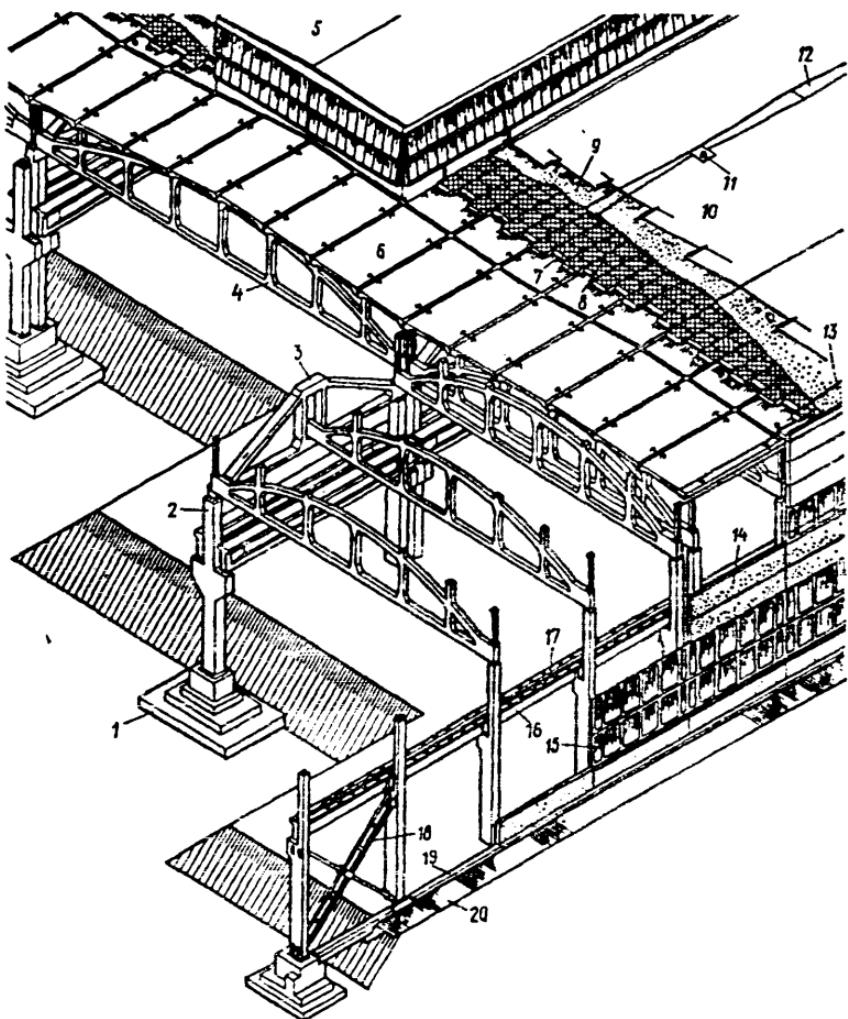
Конструктивные элементы одноэтажного здания с железобетонным каркасом:
